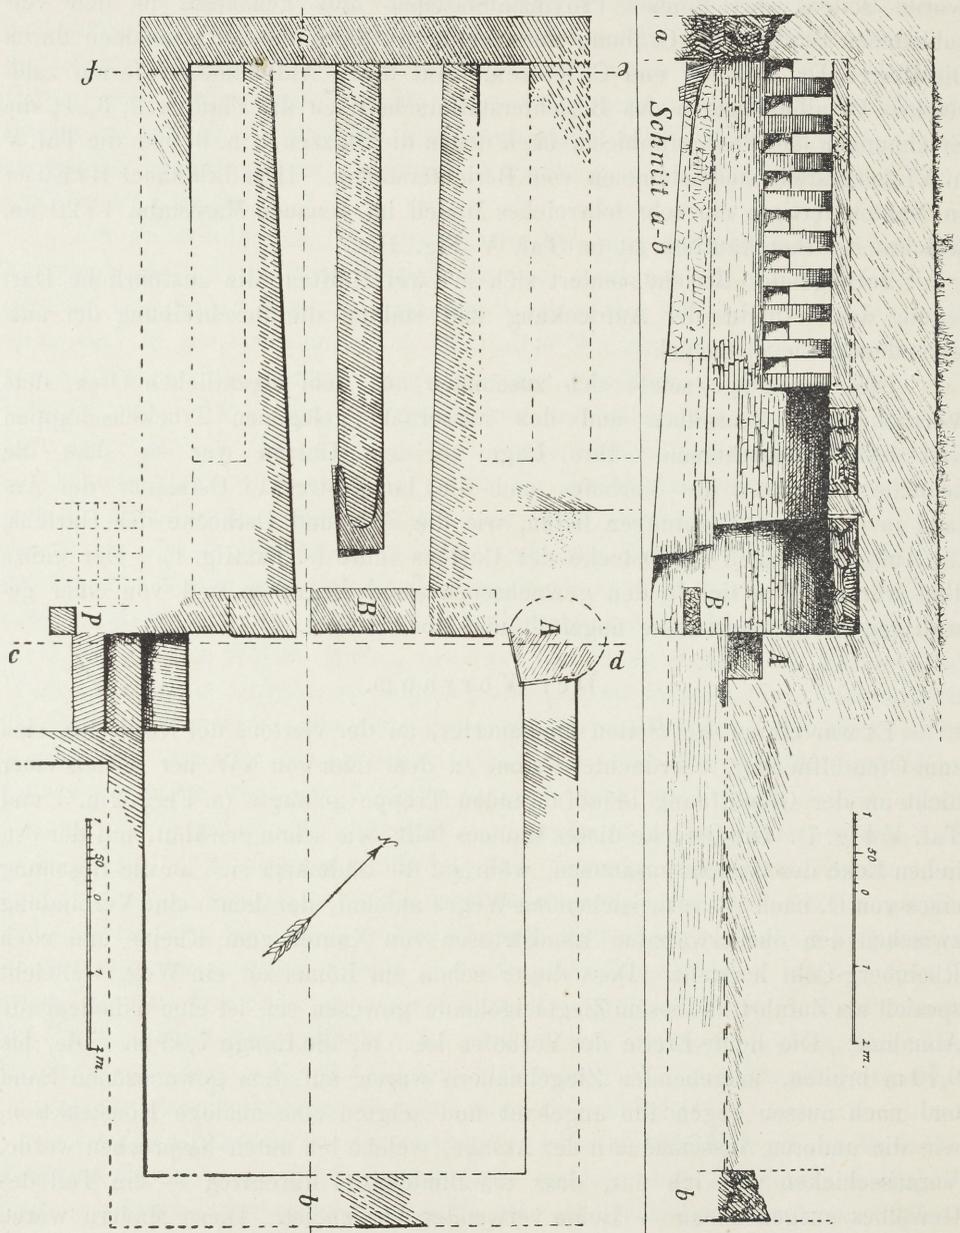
(Grundriss und Längsschnitt a-b.)
